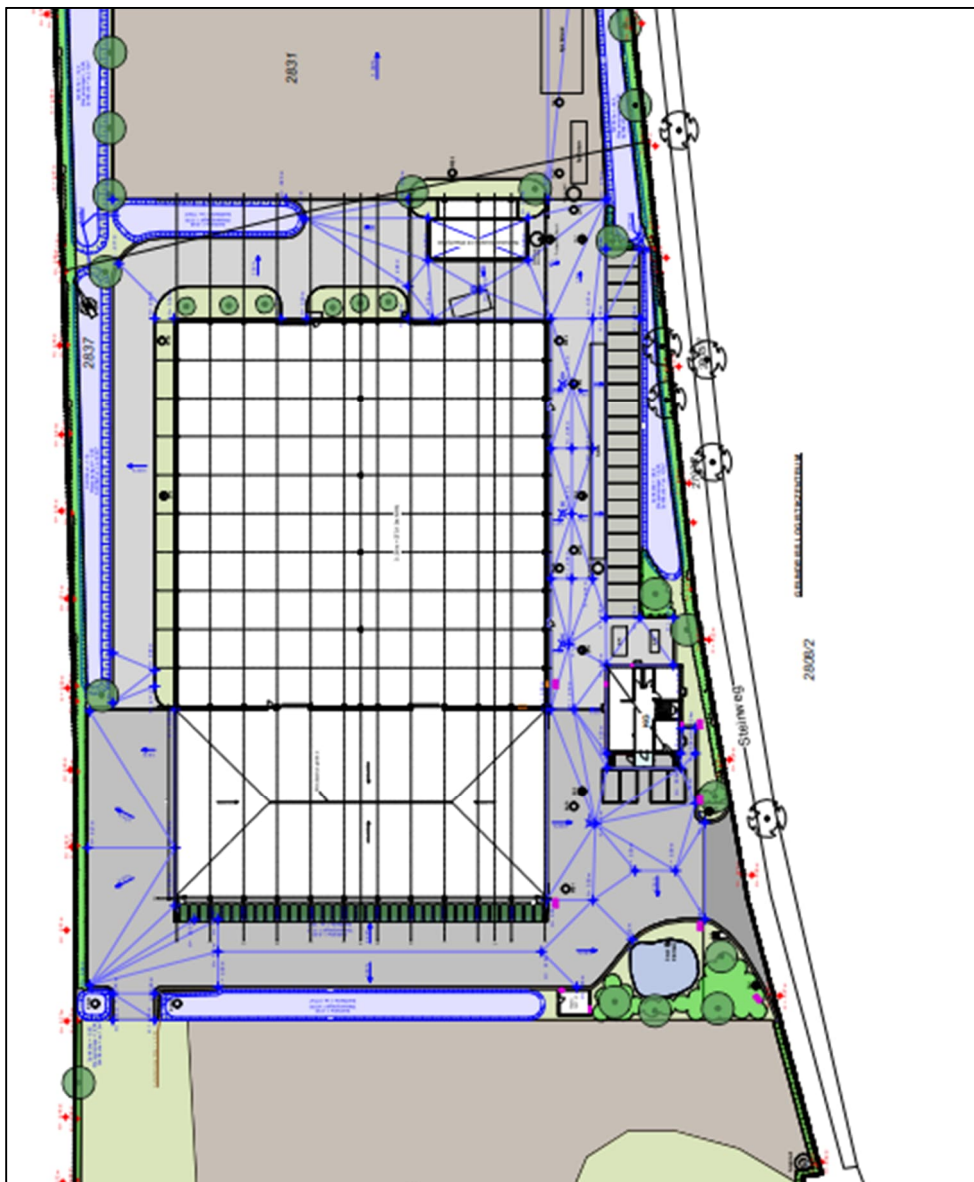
Auszug aus den Vorhaben- und Erschließungsplänen /18, 33/ mit Darstellung des Grundrisses der Logistikhalle
